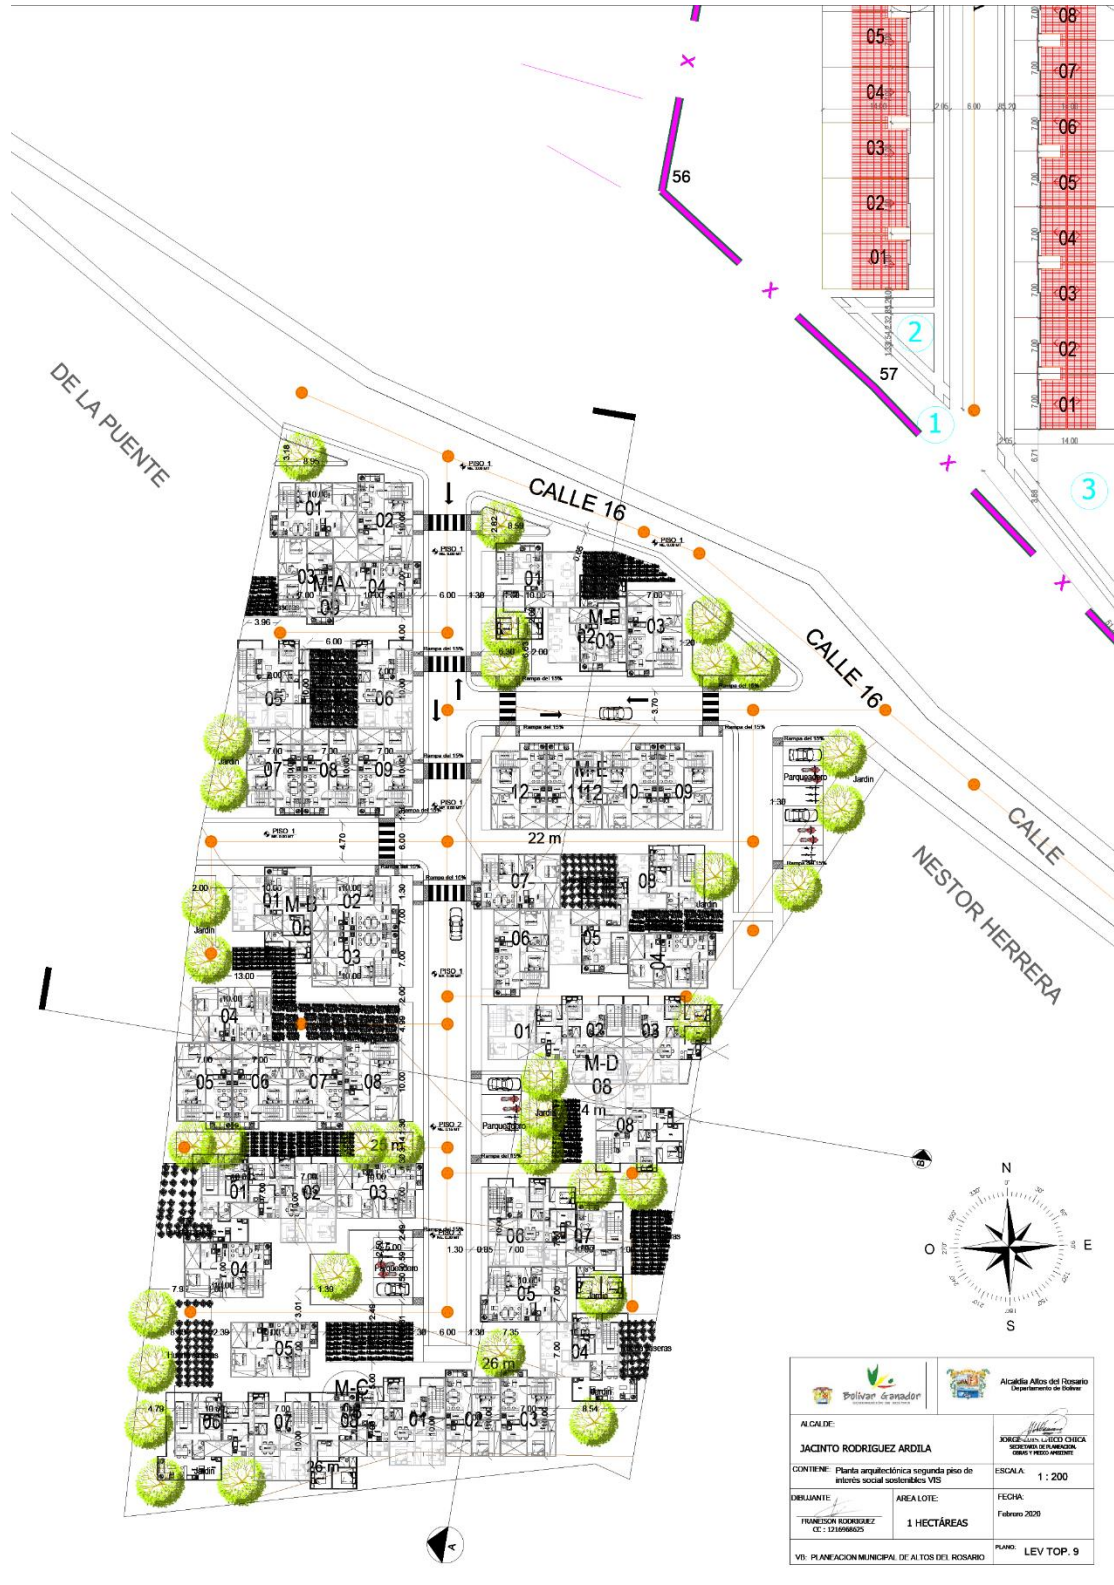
Plano segundo piso de VIS sostenible fuente autor
